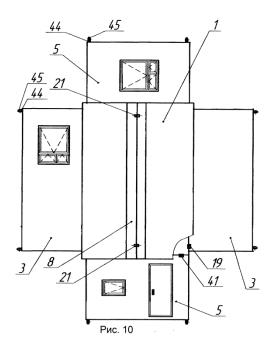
Двускатная крыша с боковыми и торцевыми панелями (вид сверху): 1-крыша; 3-торцевая панель; 5-боковая панель; 8-конек; 19-полушарнир; 21-рым-болт; 41-полушарнир; 44-башмак; 45-технологическое колесо.
